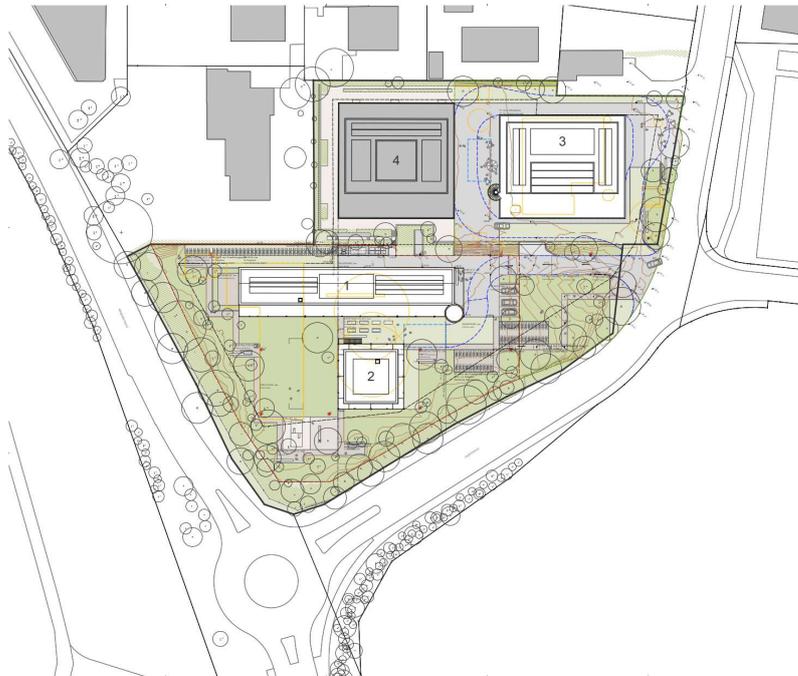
Gesamtareal Zugerstrasse 50, 50a und 52, Steinhausen, mit Ersatzneubau DSS sowie Bürogebäude Zugerstrasse 50 (ohne Massstab); 1) Wohnhaus Durchgangsstation; 2) Pavillon Durchgangsstation; 3) Ersatzneubau altes Laborgebäude; 4) Neubau Amt für Verbraucherschutz
